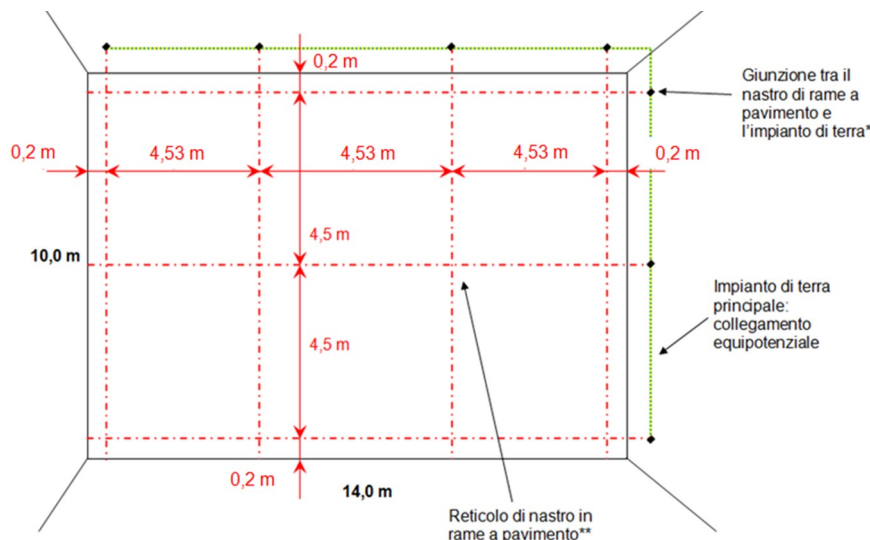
Beispiel eines Potentialausgleichsgitters in einem Raum mit rechteckigem Grundriss (14 x 10 m).
